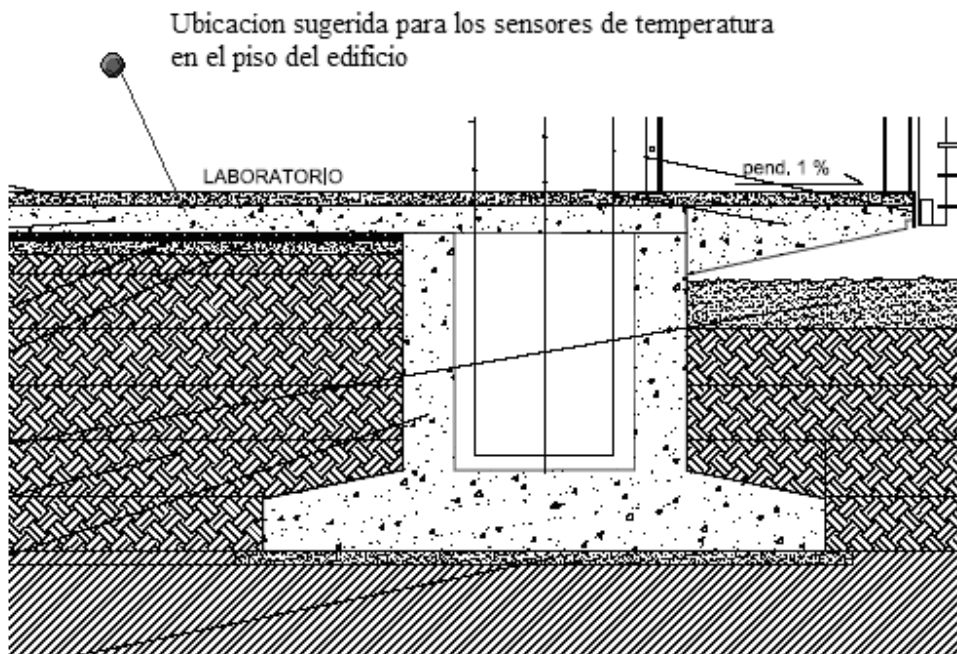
Detalle sobre la instalación de sensores en el piso.
